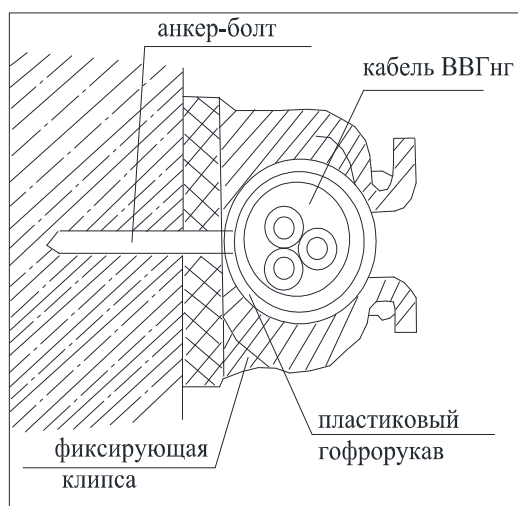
Схема крепления кабеля к стене или перекрытию с помощью нейлоновой стяжки или скобы при разводке кабеля по помещению.
